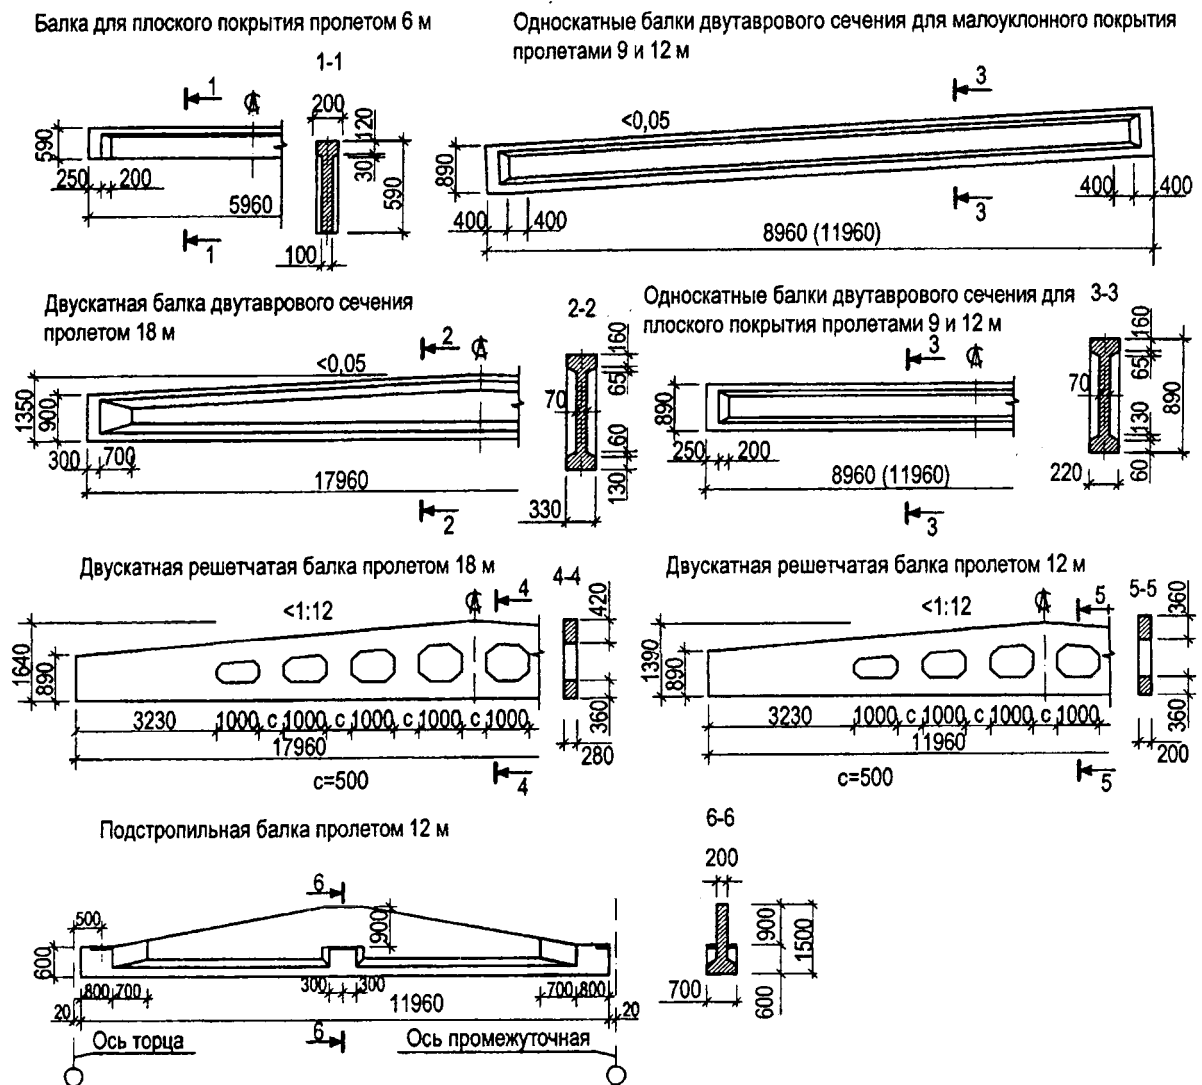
Железобетонные стропильные и подстропильные балки
